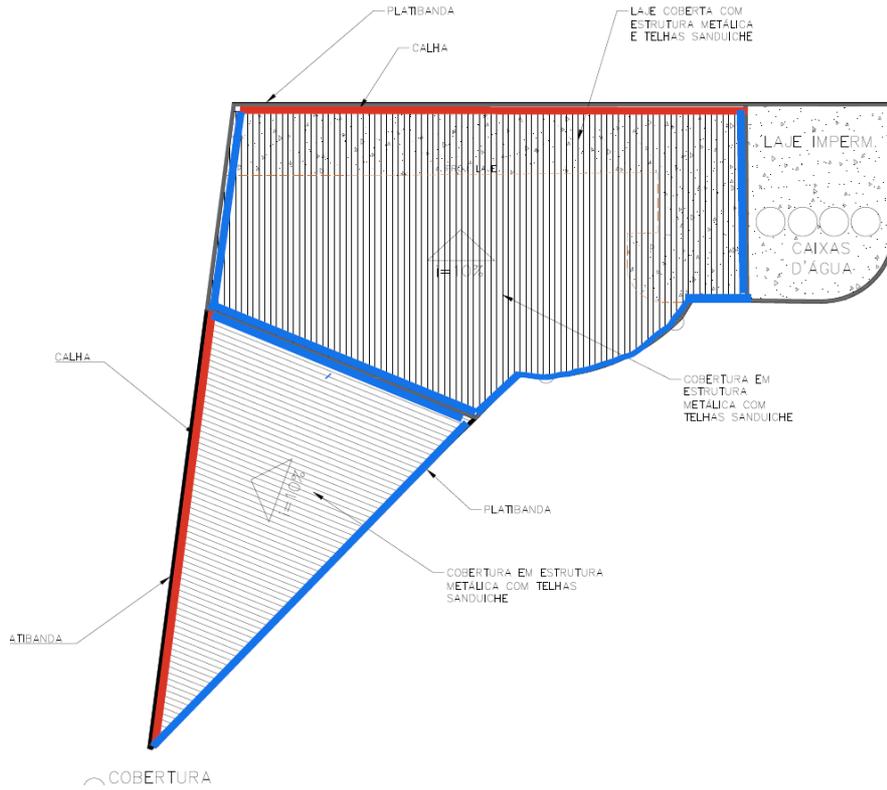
Locais em que deverão se aplicar manta impermeabilizante.
